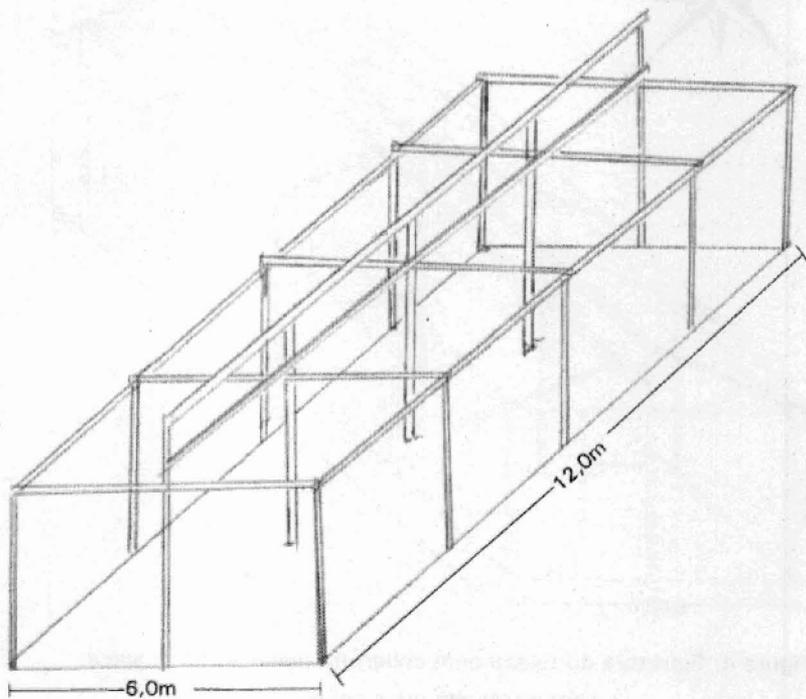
Estrutura do telado com cobertura plástica, tipo capela, antes de colocar a estrutura do teto.
